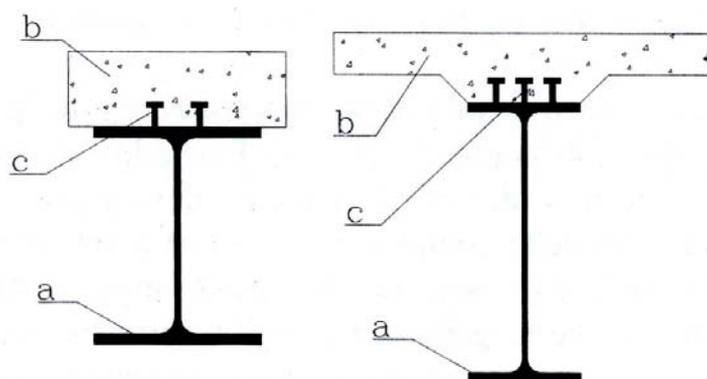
Schema di una trave composta in acciaio-calcestruzzo
